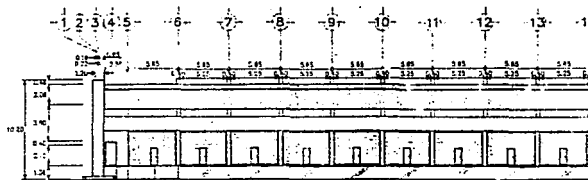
FACHADA LONGITUDINAL 1 ZONA DE DESCARGA
